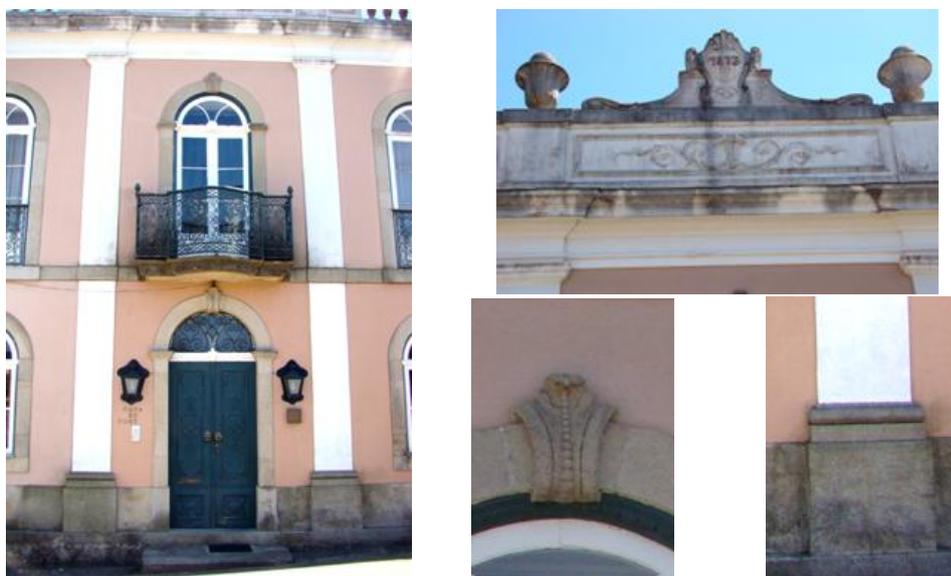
Casa de Fontes – Fachada Principal – Pormenores da Porta e da Janela do rés do chão
